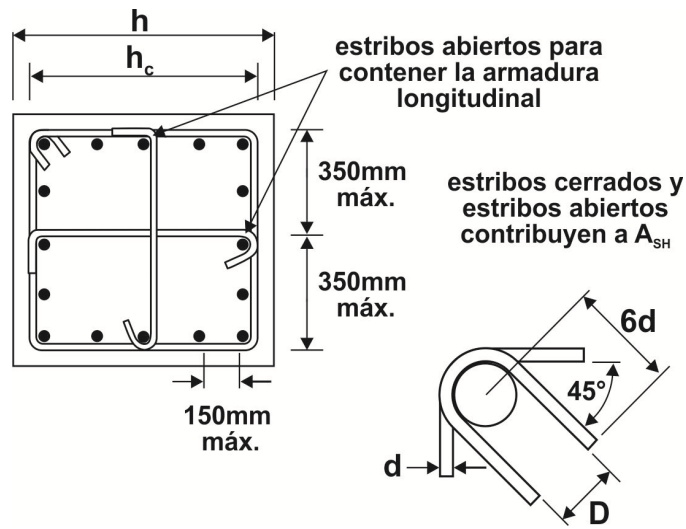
2: Detalles de Estribos en Columnas
